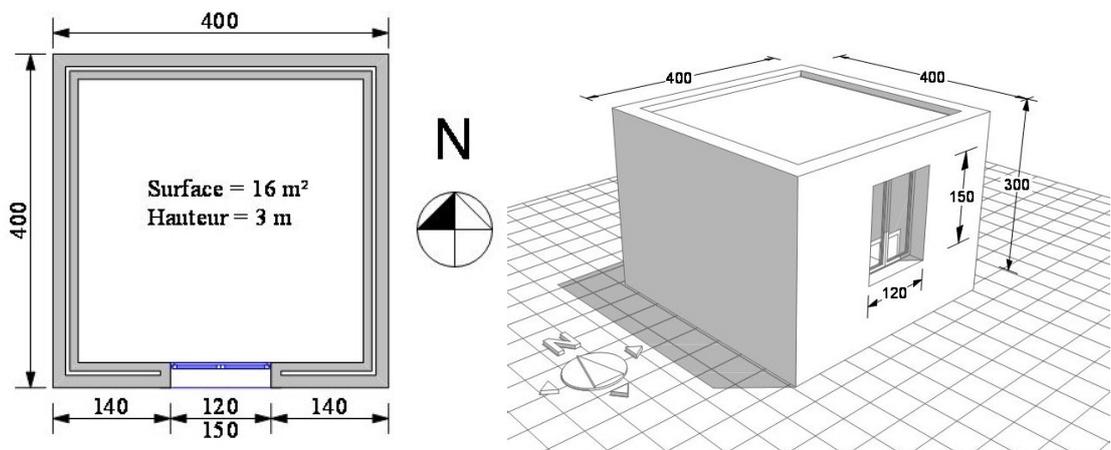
Plan et 3D du bâtiment cas de base. (Source : auteur)
